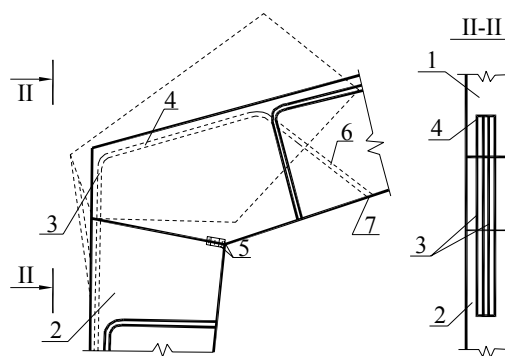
Соединение ригеля со стойкой [7]: 1 – ригель; 2 – стойка; 3 – арматурные выпуски стойки; 4 – выемка по внешнему контуру; 5 – закладные детали; 6 – отверстие ригеля; 7 – анкер
